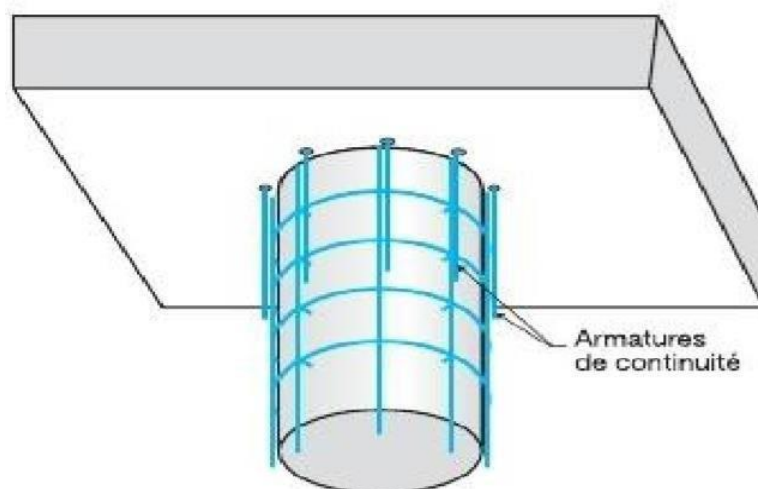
Chemisage en béton armé des poteaux (ferrailage complet)
